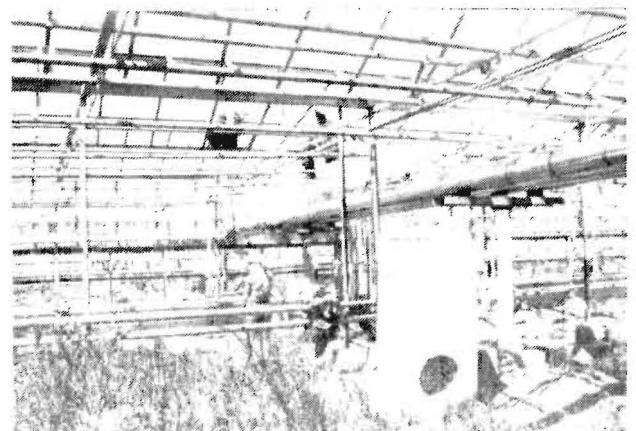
Auch eine Gewächshausmontage (im Bild ein MZG-2) ist durch die Vielzahl der beteiligten Gewerke gekennzeichnet, wie Stahlmontage, Lüftungsbau, Rohrleitungsbau, Verglasung und Elektroinstallation
